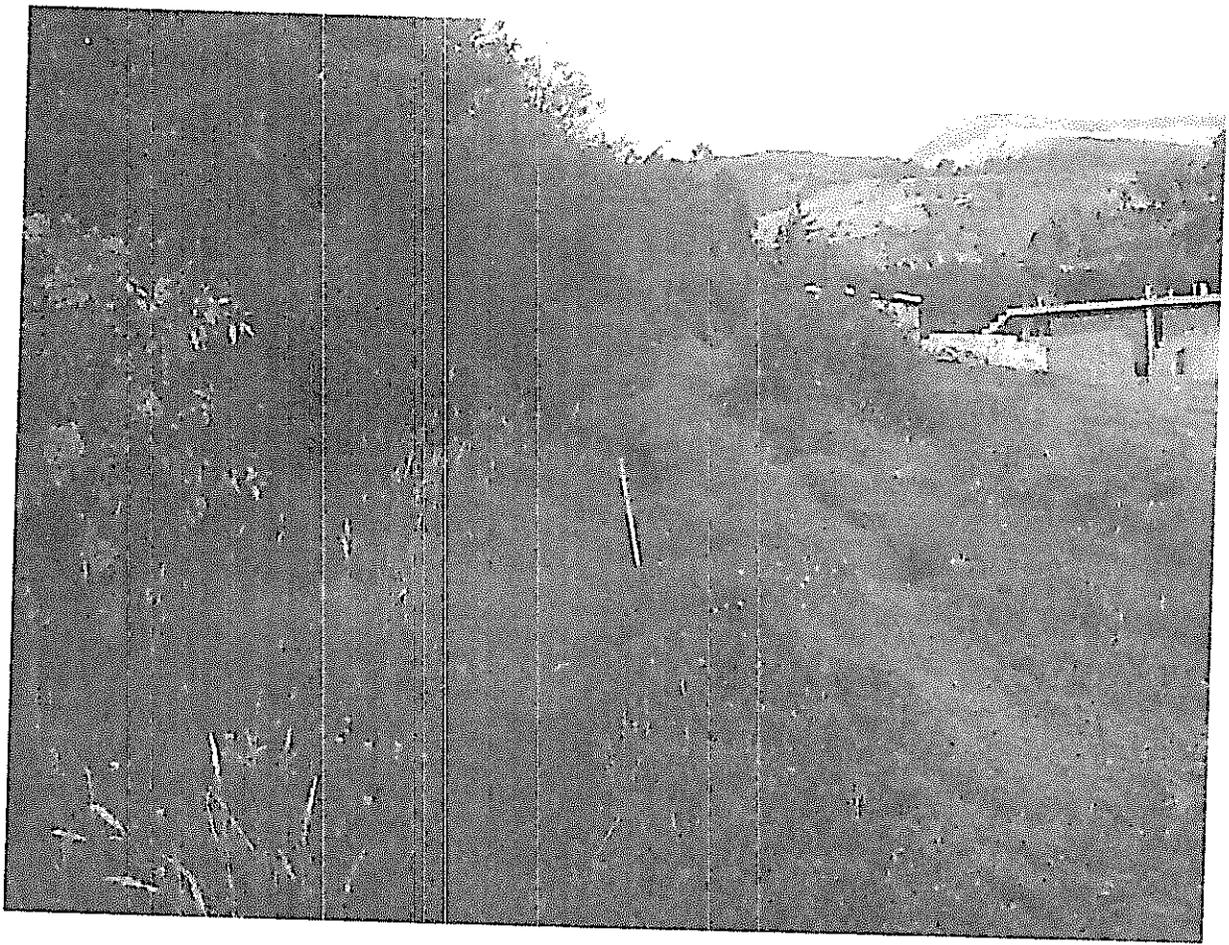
LINDERO CERCA VIVA Y REPLANTEO CON ESTACA COLOCADA POR TOP. R. GUALOTO
